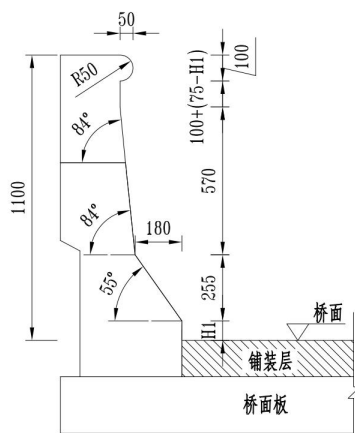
加高混凝土桥梁护栏构造 (mm)
